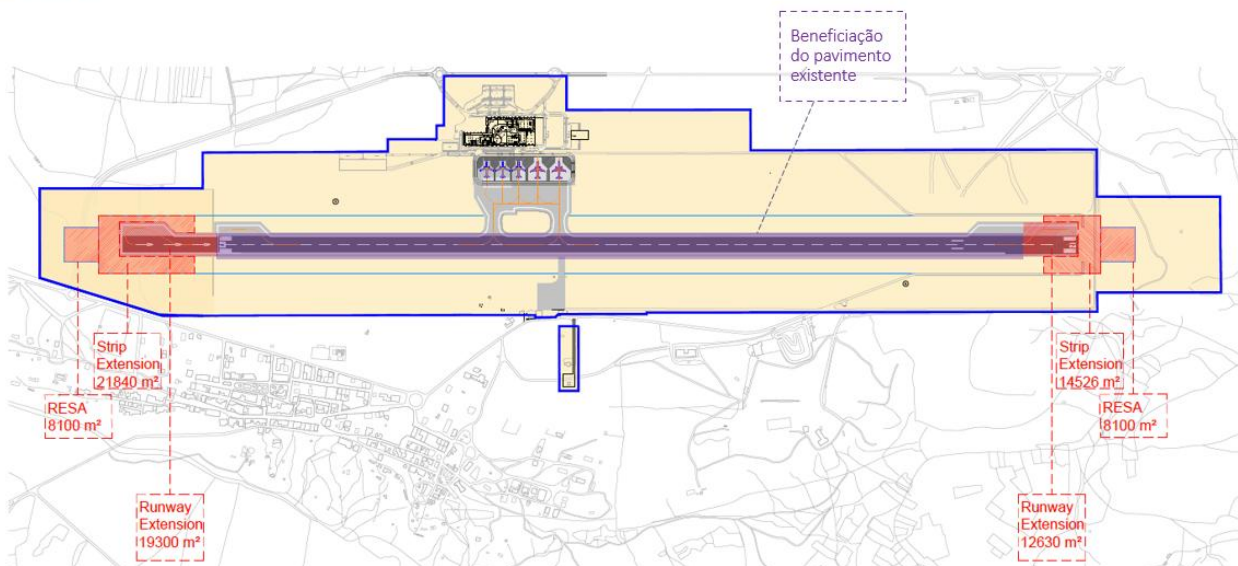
| Trabalhos de repavimentação e extensão da pista BVC – Localização
